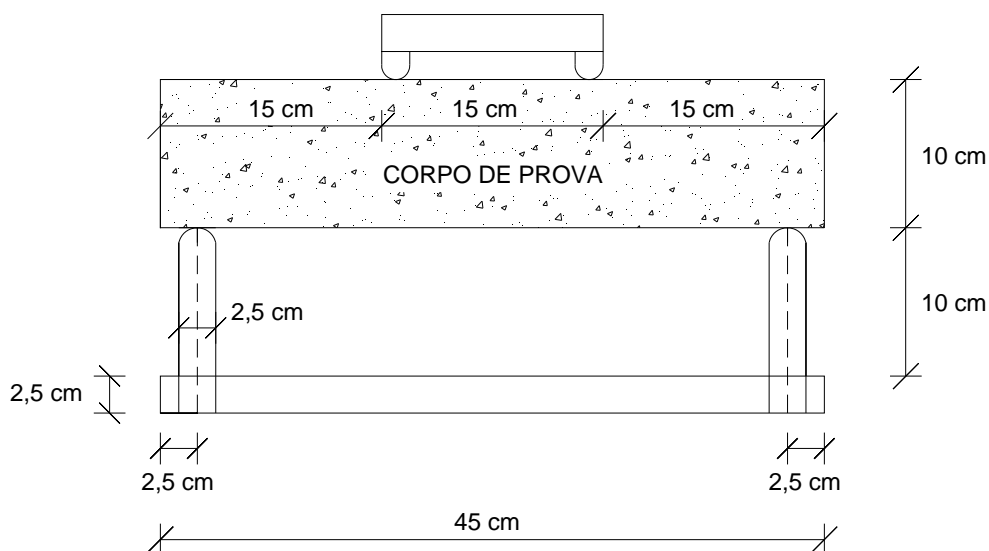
Ilustração esquemática do aparato para o ensaio de tração na flexão.
